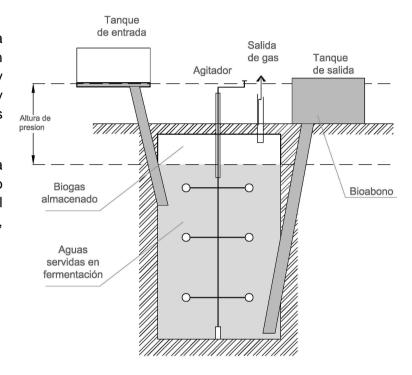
Esquema de Biodigestor de campana fija, de concreto armado in situ
